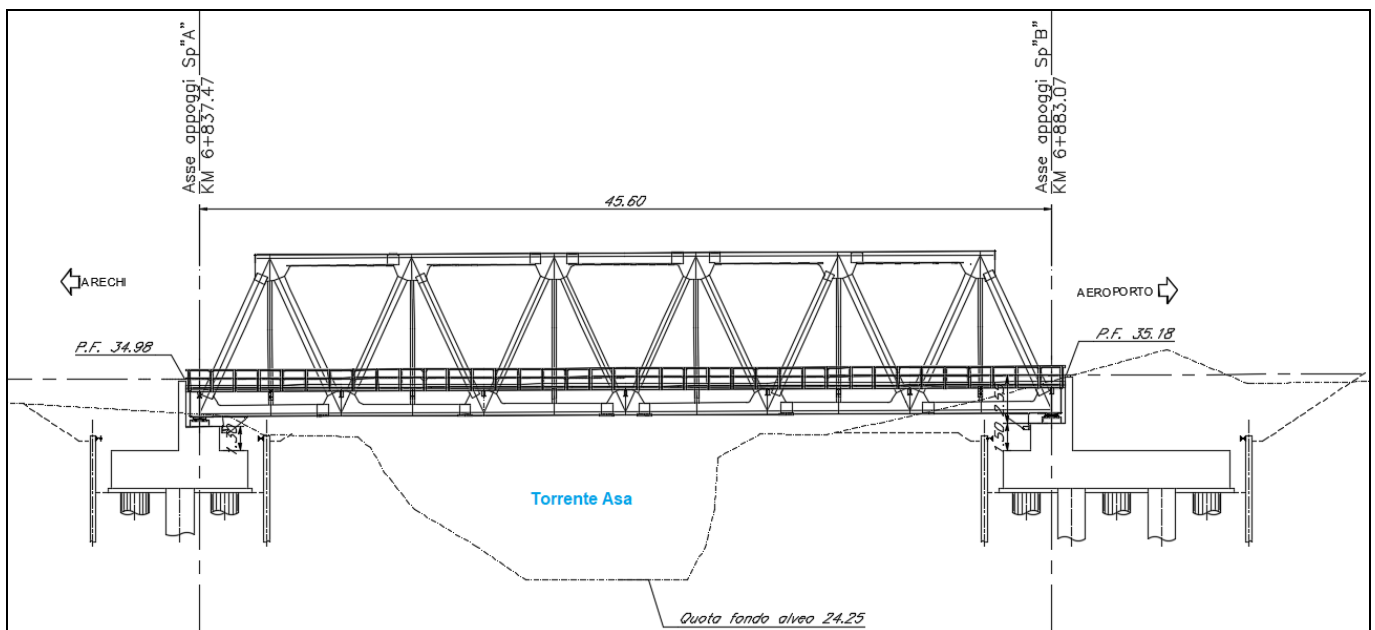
Viadotto VI03 sul Torrente Asa: prospetto.
